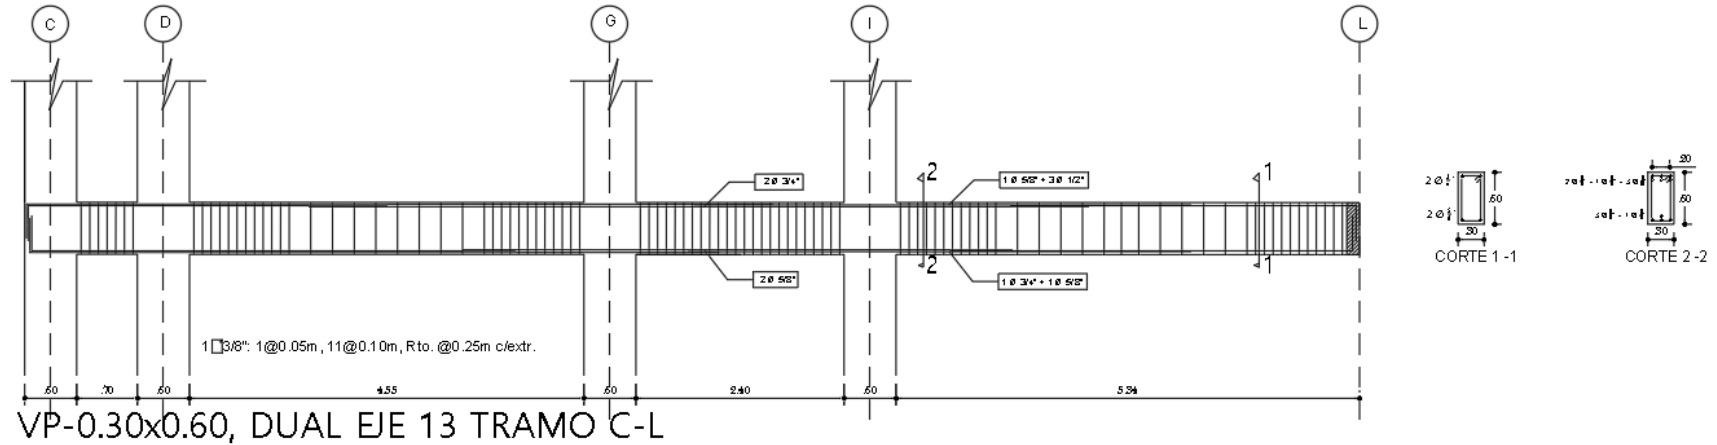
Detalle del acero longitudinal y de refuerzo de la viga principal, comprendido desde el eje C hasta el eje L, de la losa Vigacero de concreto convencional  $f'c=280\text{kgcm}^2$ .
